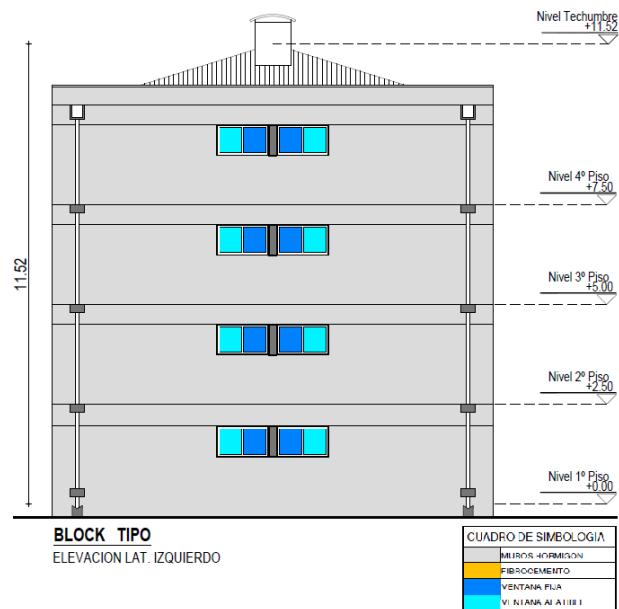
Elevación block tipo. Fuente: Elaboración propia.
